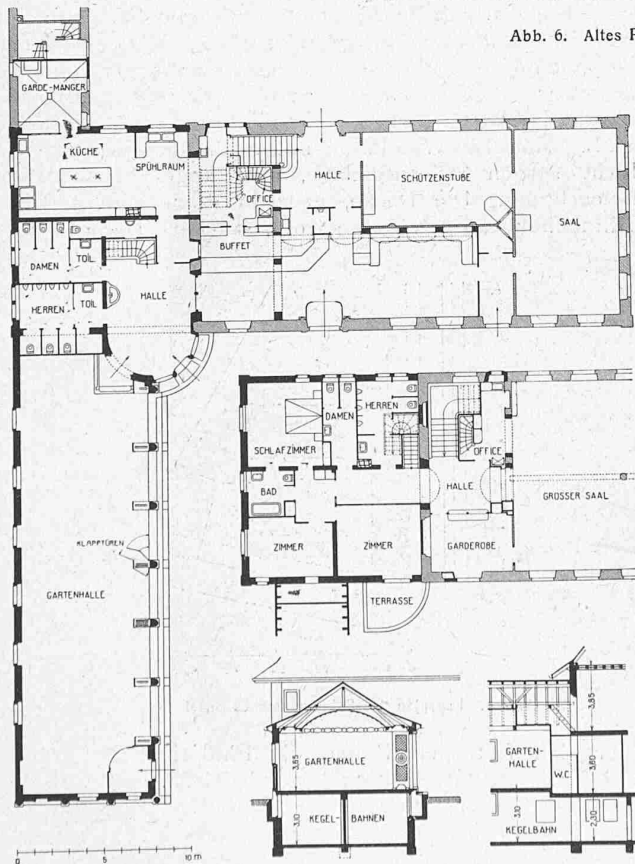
Grundrisse mit Schnitten der Gartenhalle. — Masstab 1:400.
